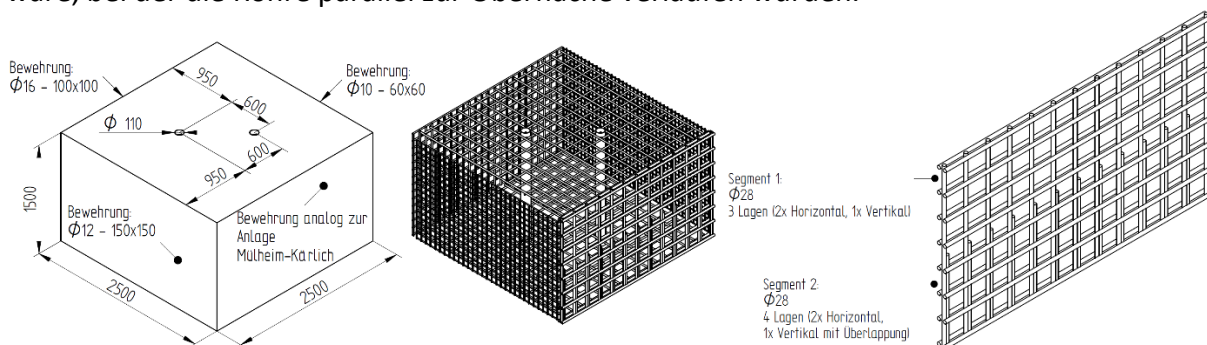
3D-Modell des Laborprobekörpers. Links: Außenansicht; Mitte: Innenansicht mit Bewehrung und eingebetteten PVC-Rohren; Rechts: Bewehrung analog zur Anlage Mülheim-Kärlich.
